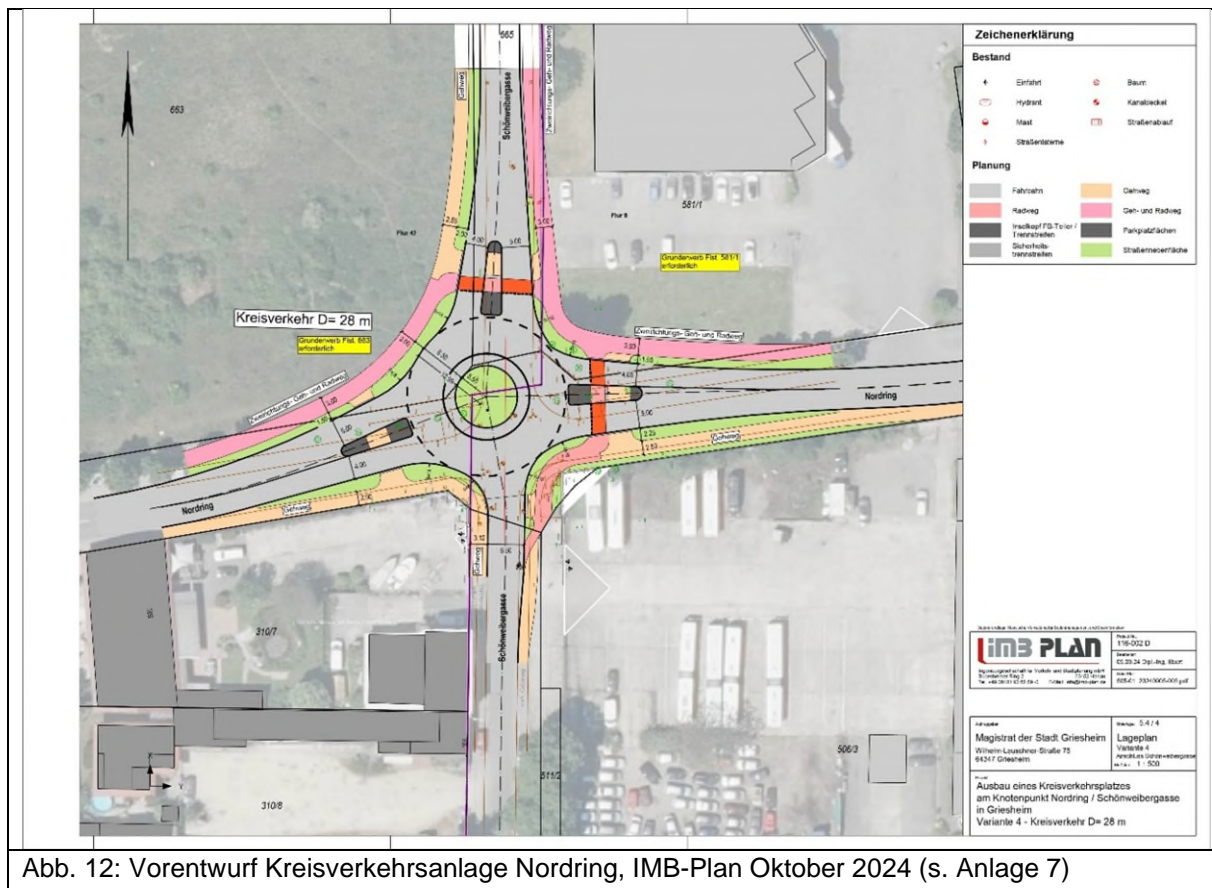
Vorentwurf Kreisverkehrsanlage Nordring, IMB-Plan Oktober 2024 (s. Anlage 7)
